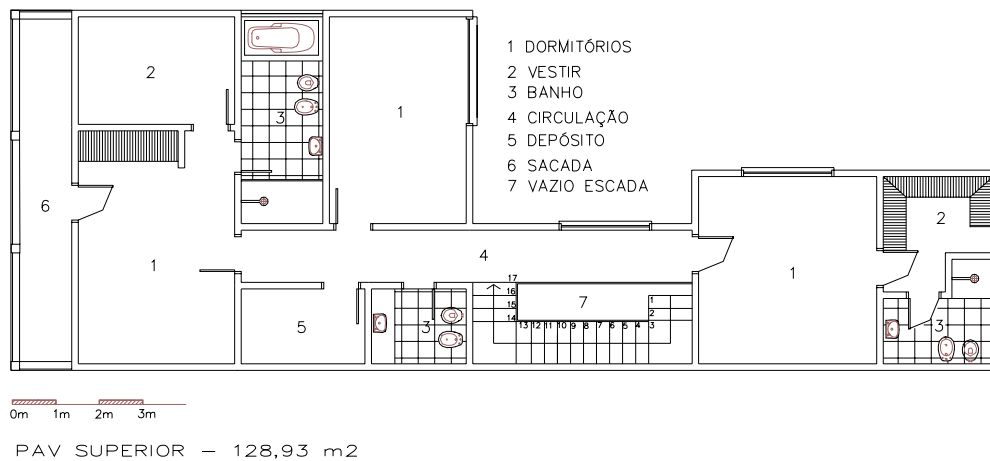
Plantas baixas da casa Rômulo Teixeira.
